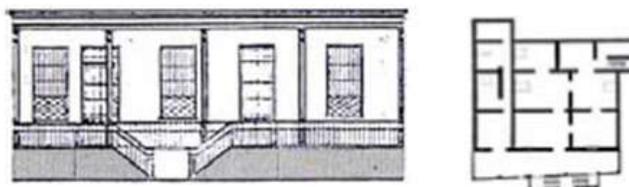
Ranchos que se construyeron en la bajada de baños y alrededores
